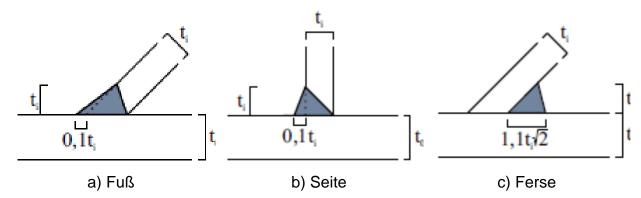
Diskretisierung der Schweißnaht bei RHP K-Knoten Figure 5-2 Weld seam discretization for RHS K-joints
